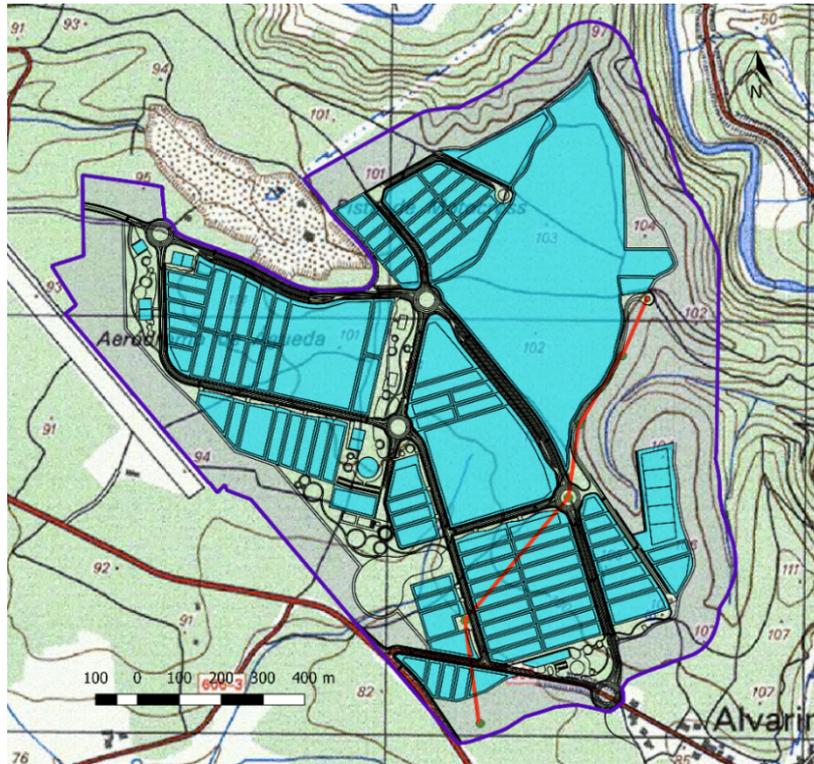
Rede de Média Tensão (vermelho) sobre Planta do PEC.
